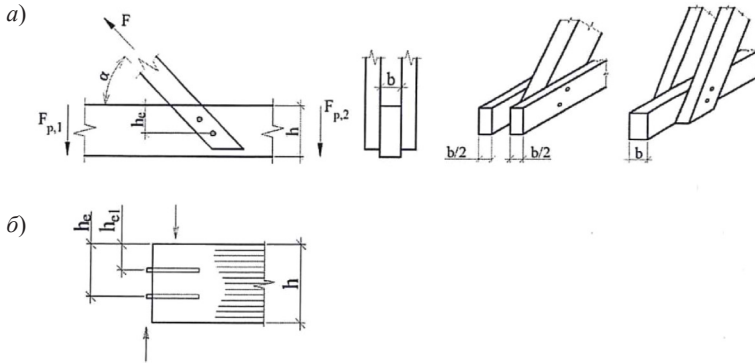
Схемы нагельных соединений для расчетов на раскалывание:
